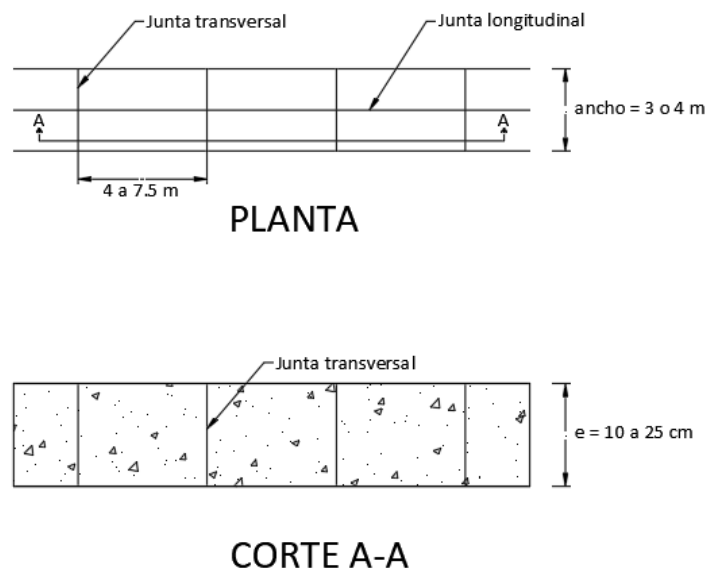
Pavimento de concreto hidráulico simple sin pasadores
